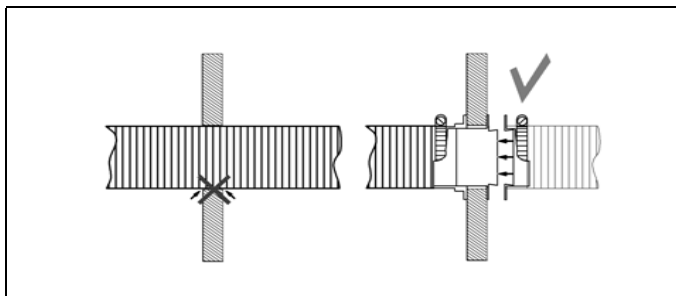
Рекомендуемая прокладка воздуховодов через переборки с использованием специального прохода в стене
